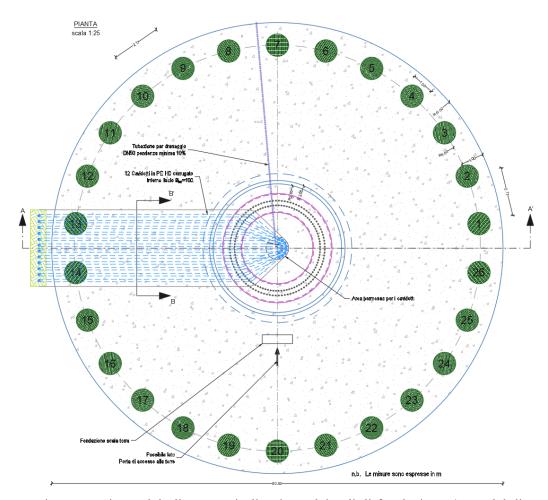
Pianta del plinto con indicazione dei pali di fondazione (n.26 del diametro 1000mm)
